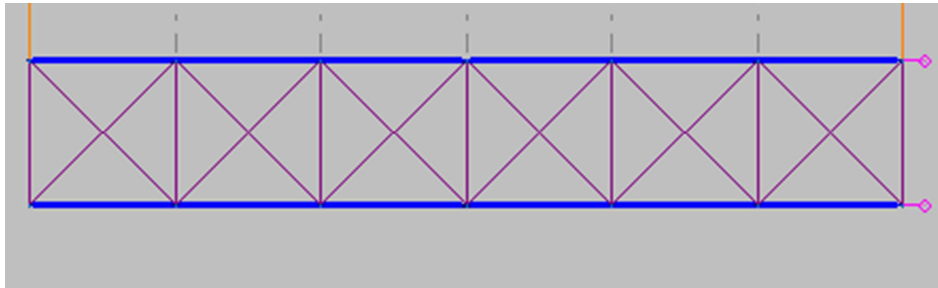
Viga contraviento. (Fuente CYPE 3D).
